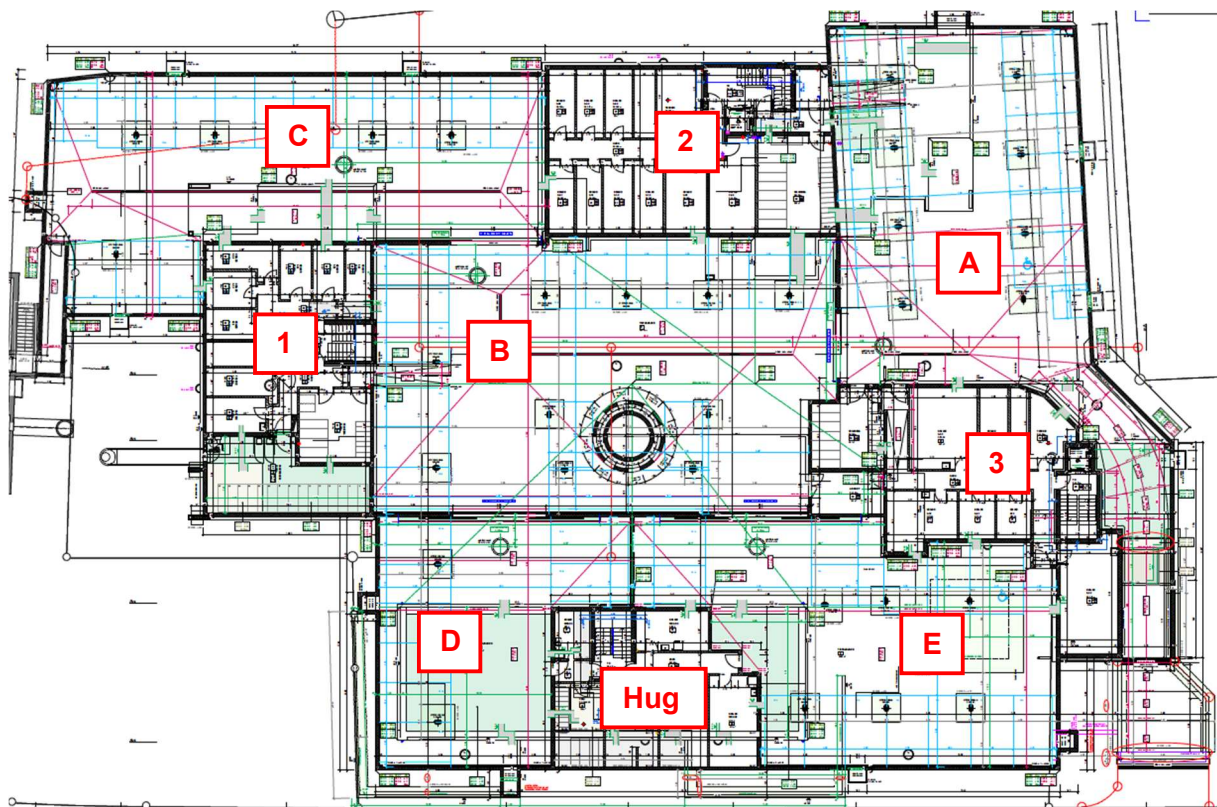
Grundriss Untergeschoss (Architekt)
